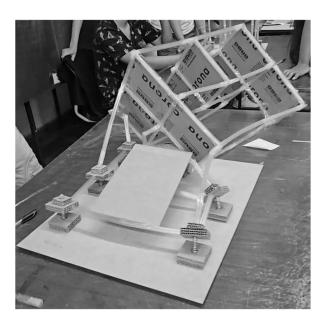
Colapso observado por ubicación irregular de muros estructurales.
